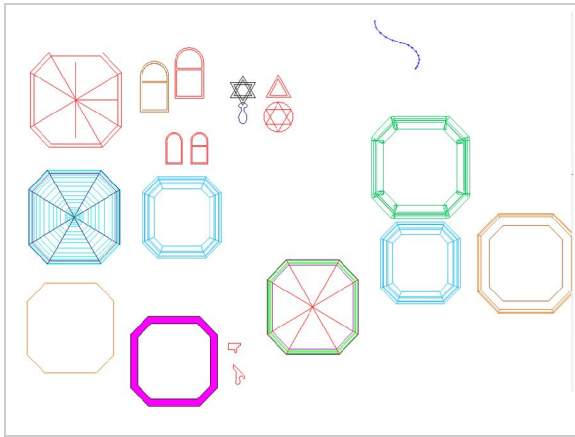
Montage der Laternenelemente im Grundriss.
